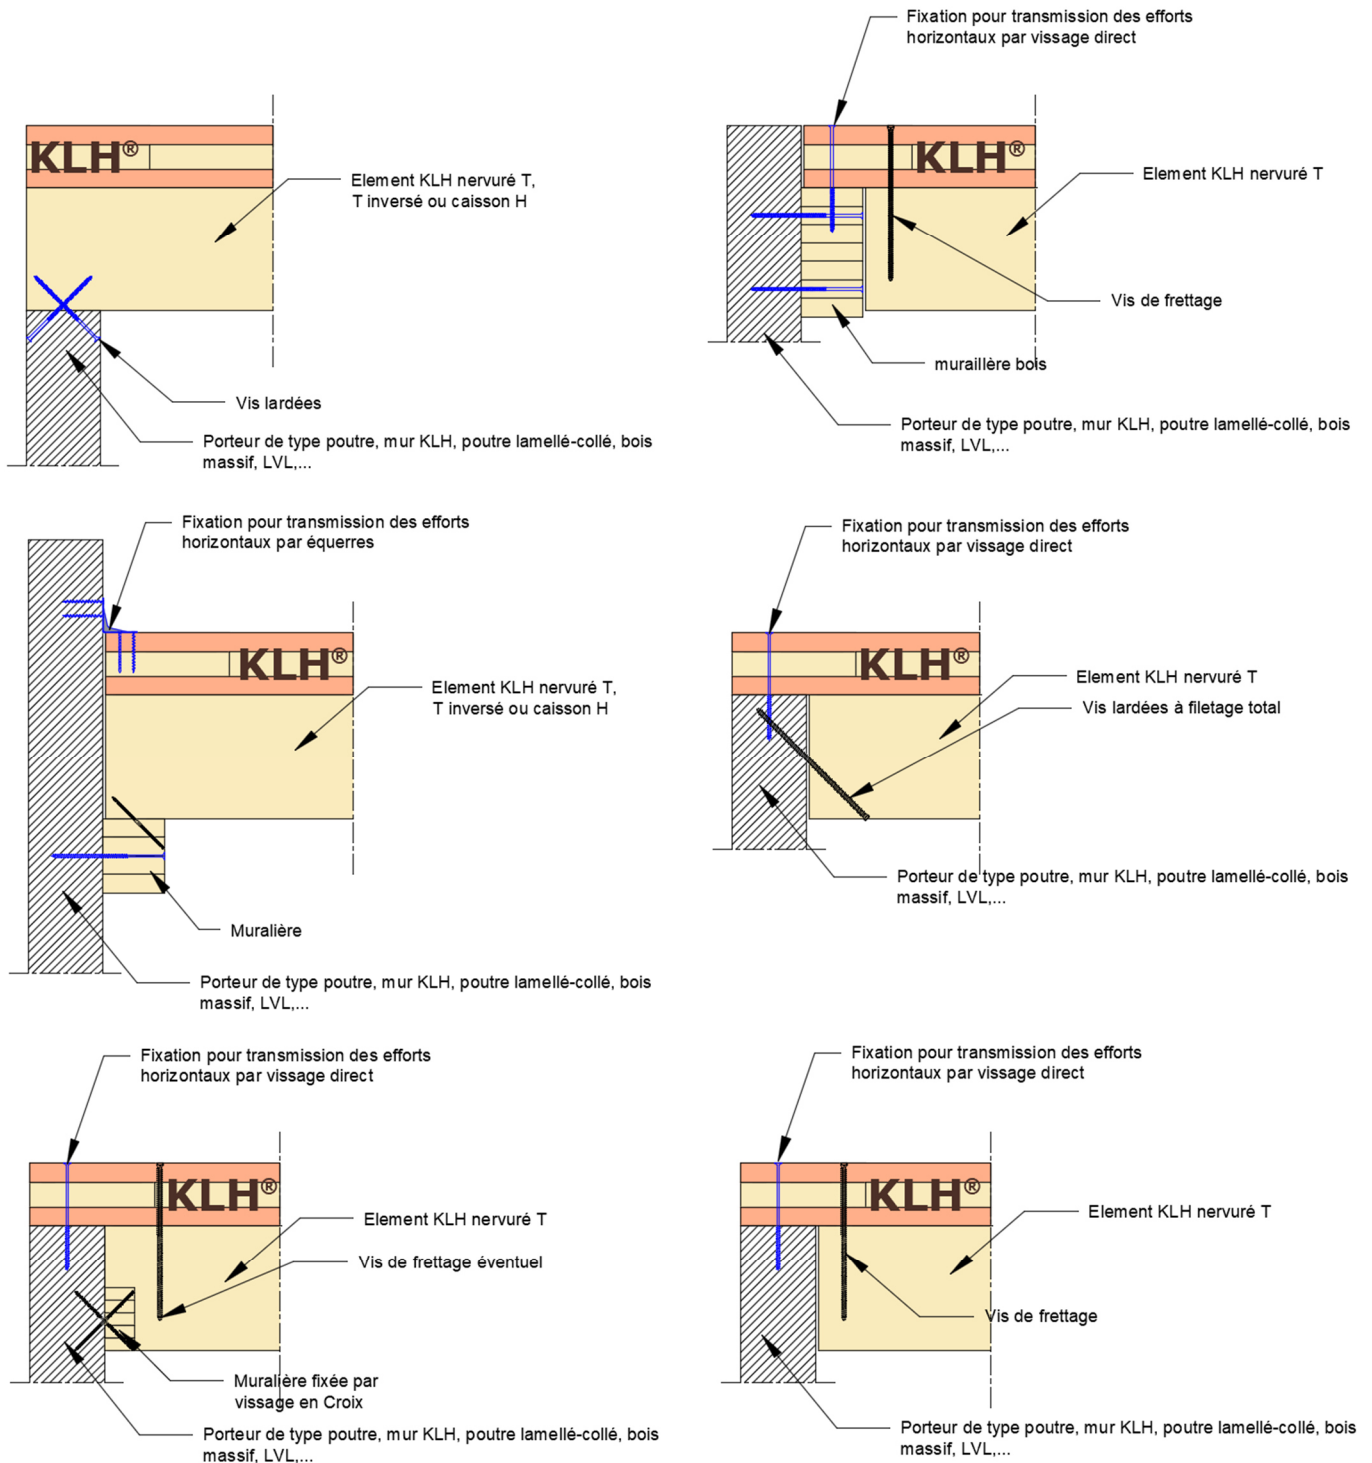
Détails d'appuis usuels sur porteur bois (murs KLH®-CLT, mur à ossature bois, poutre bois en bois massif, en bois lamellé-collé, LVL...)
